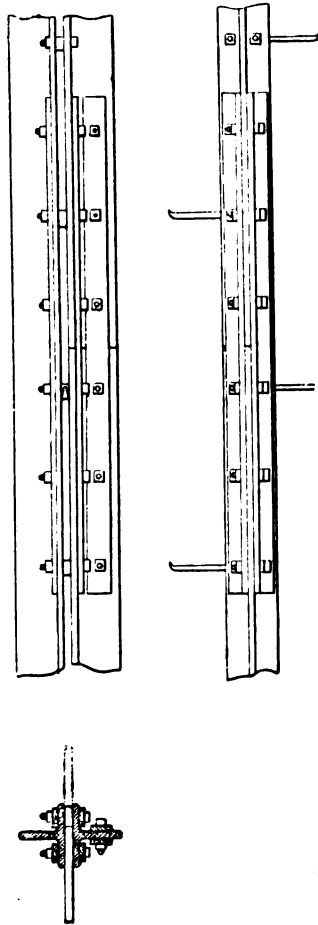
Raccordement de 2 barres d'un poteau mâté.
